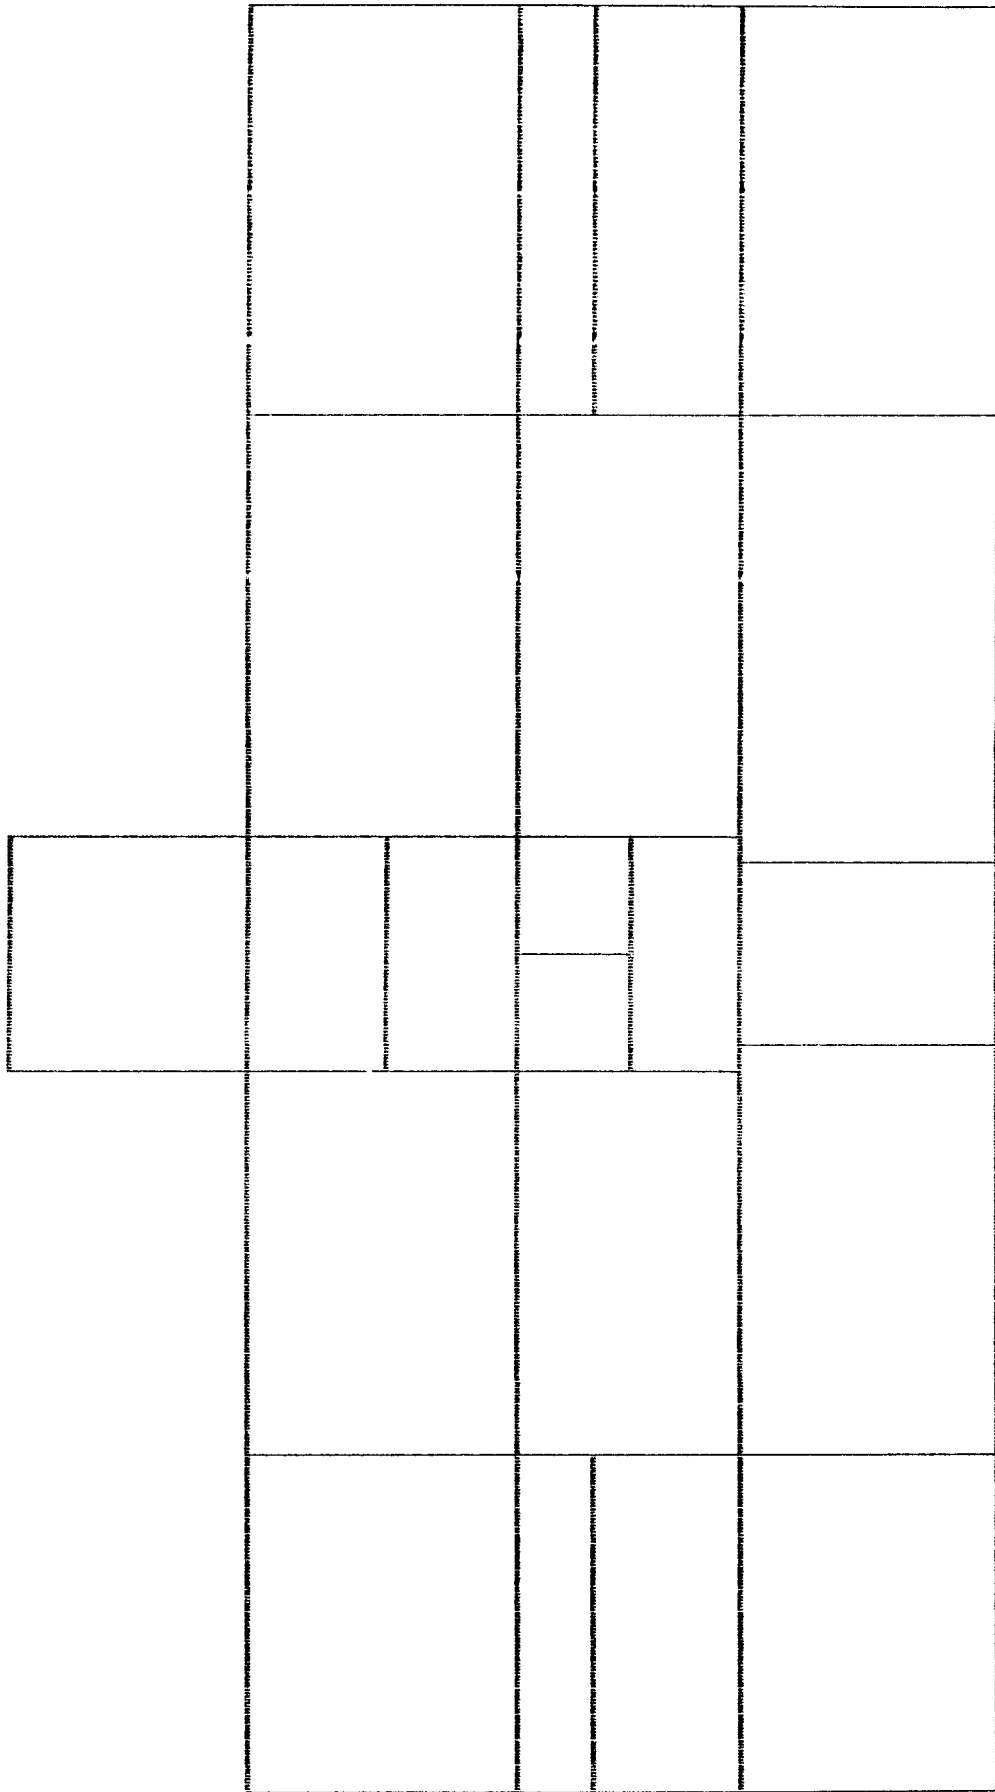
Vista em planta do 3.º pavimento (transição)
